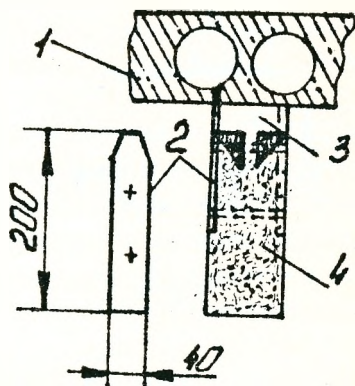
Крепление перегородок к плитам перекрытия.
